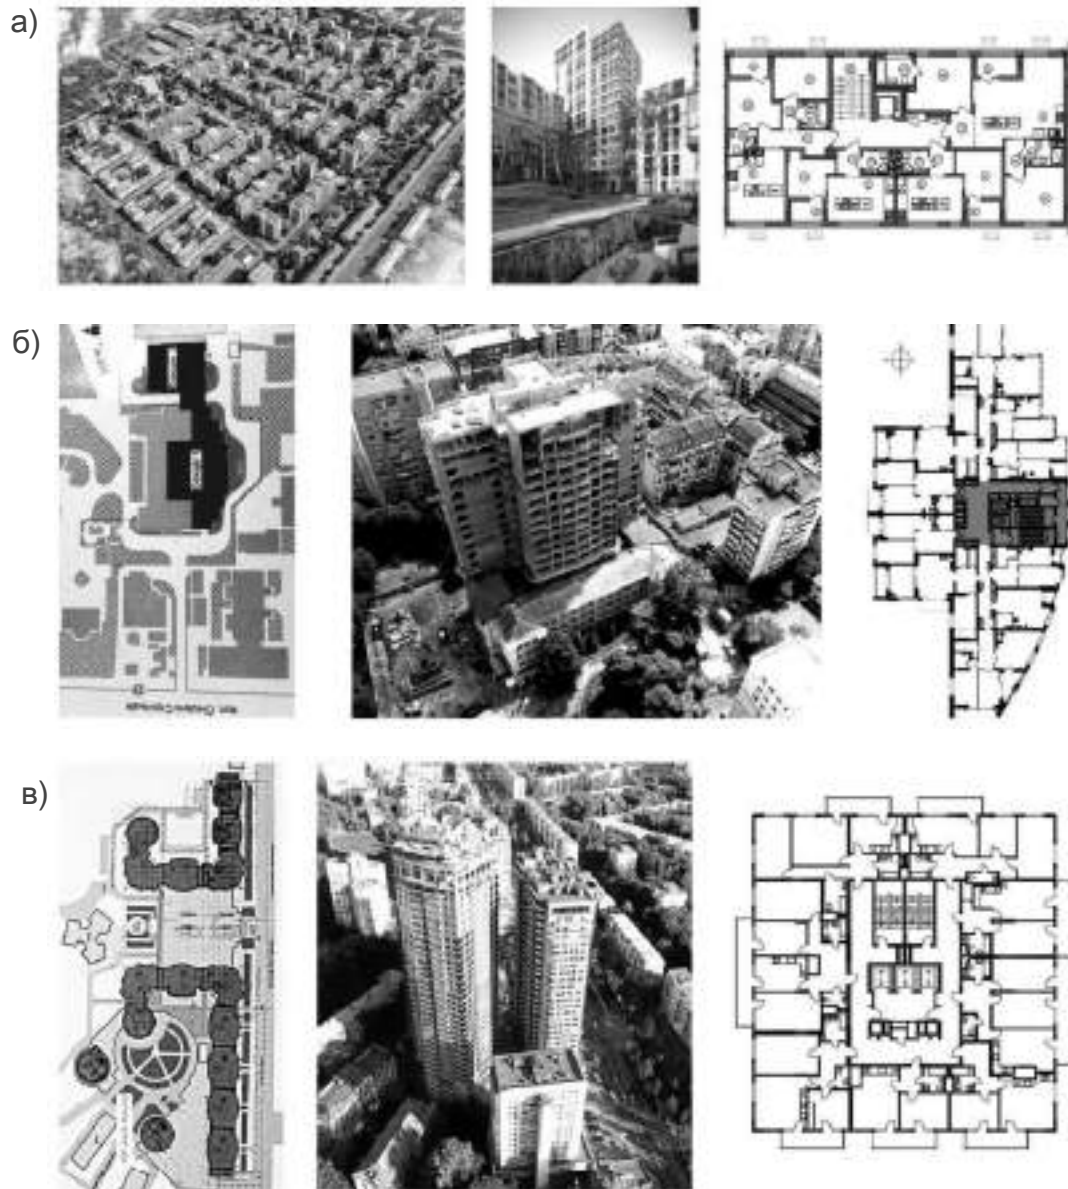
а. ЖМ «Файна Таун», (проект), 54 га, 57 будинків, 8,5 тис. кв., 6-9 пов. Загальний вигляд забудови, план поверху житлової секції б. ЖК «А52», вул. Січових Стрільців 52а. Генплан, загальний вигляд, план поверху в. ЖК «Jack House», бул. Лесі Українки, 7-9. Генплан, загальний вигляд, план поверху за Книшем В.І, Яблонською Г.Д. [23 с.258,259]
